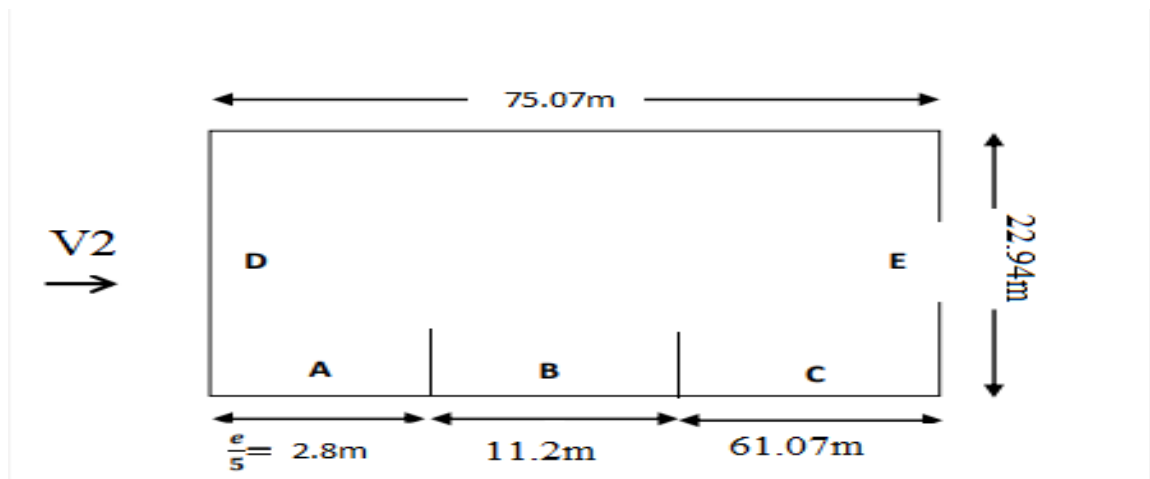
vue en plan des zones de pression sur les parois verticales sens V2.
